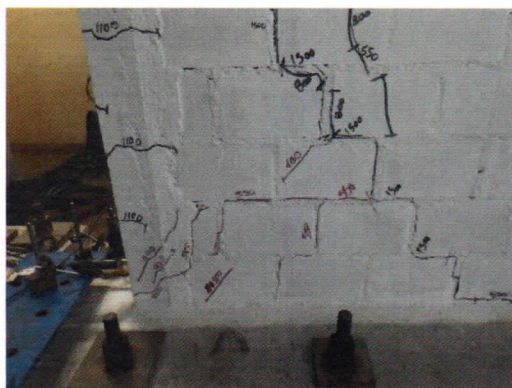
Formación de grietas diagonales en el talón Oeste de la cara Sur para una distorsión de 1/400.
